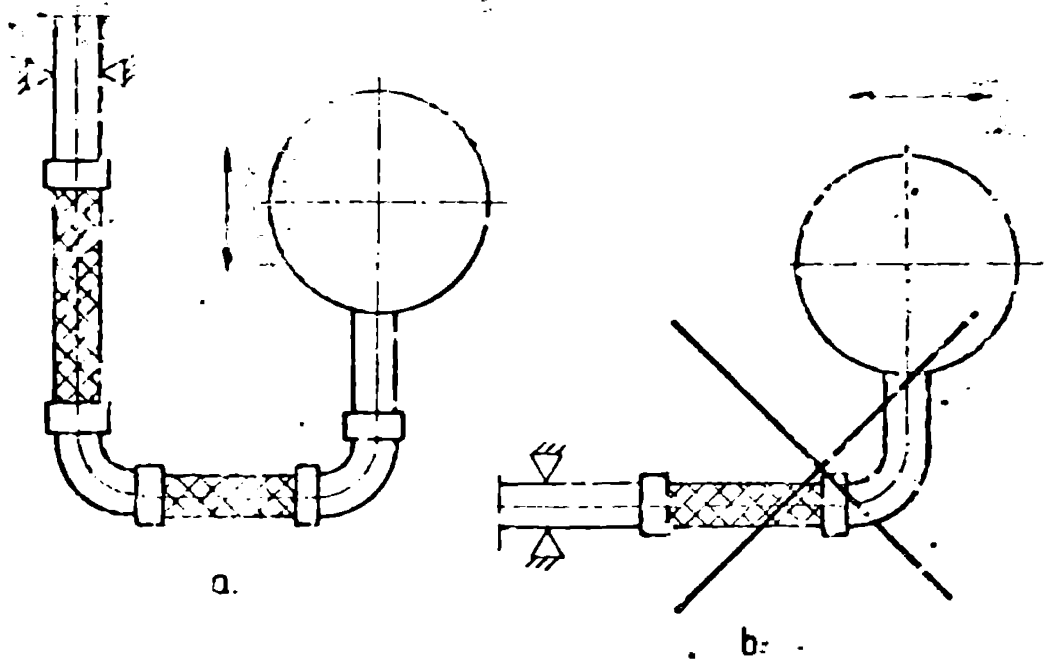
67 Montaj în unghi de 90° cu două tuburi flexibile.
